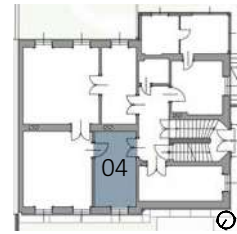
Grundriss OG 04 Kabinett vor dem Klavierzimmer, M=1:100.
